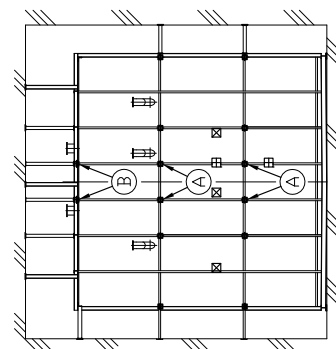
(4) 配管配置図 (炉下室(S)断面)
